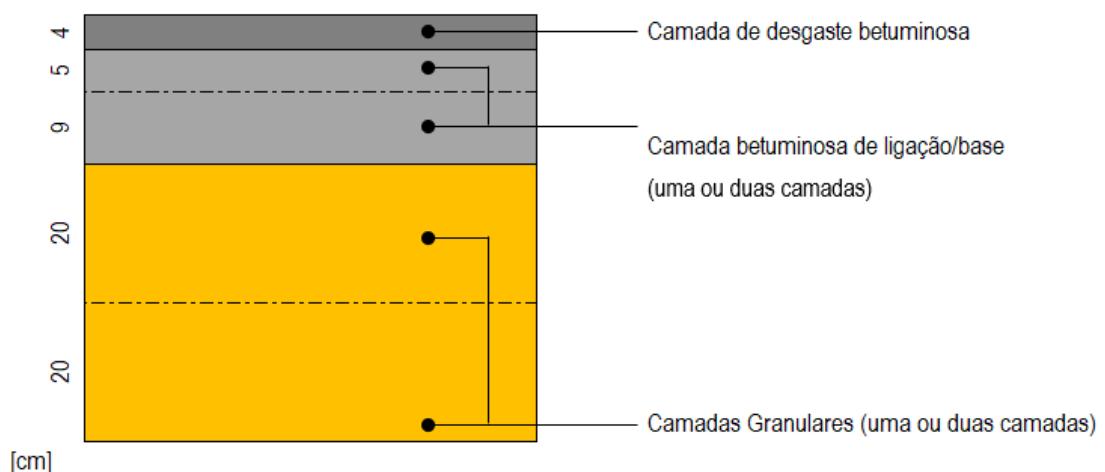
Estrutura do pavimento para acessos e estradas interiores
